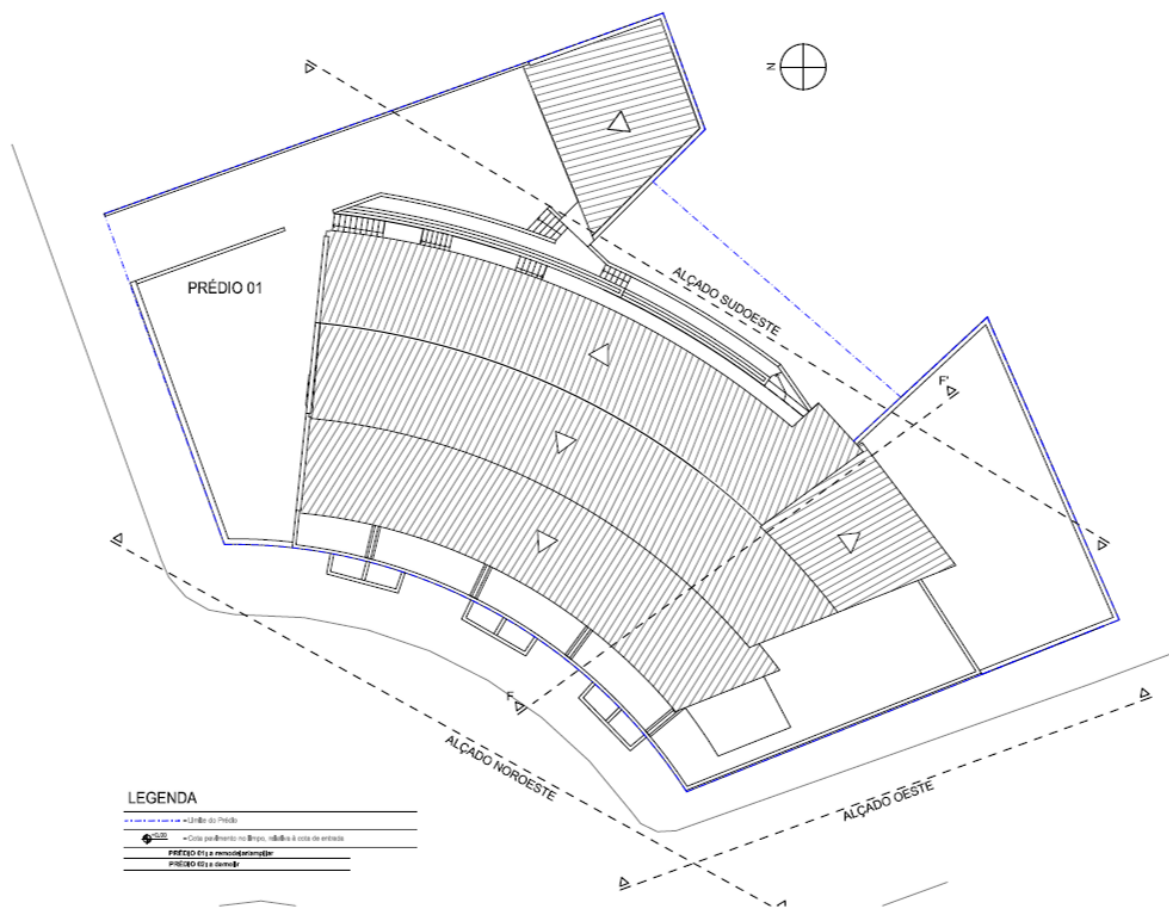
Planta da cobertura - Edifício existente [Atelier B2, 2016]
